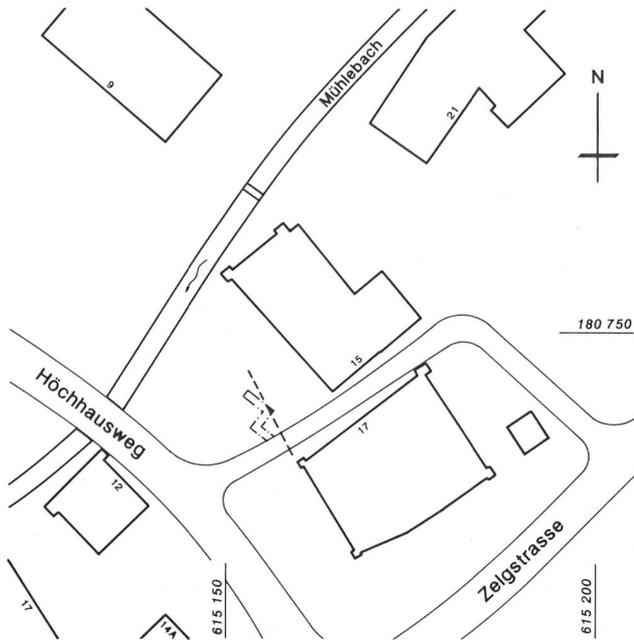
Steffisburg, Höchhausweg 15. Situationsplan M. 1:1000 mit Mauerbefund.
